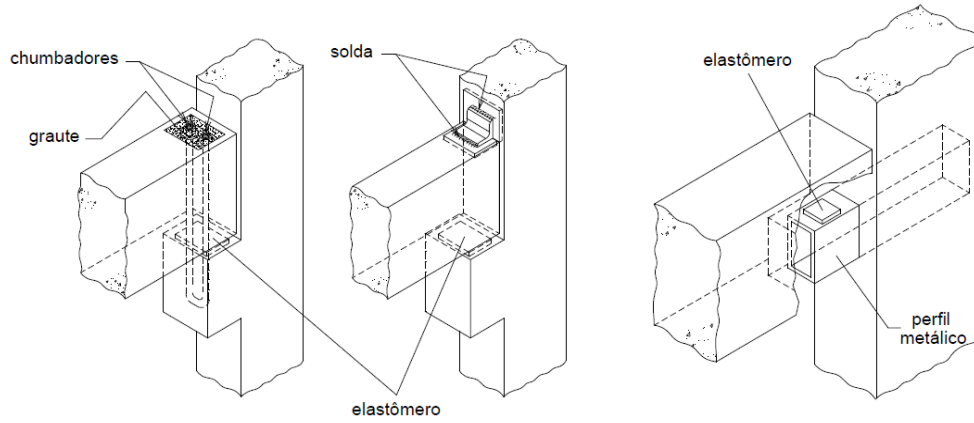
Ligações viga-pilar articuladas [El Debs (2000)].
